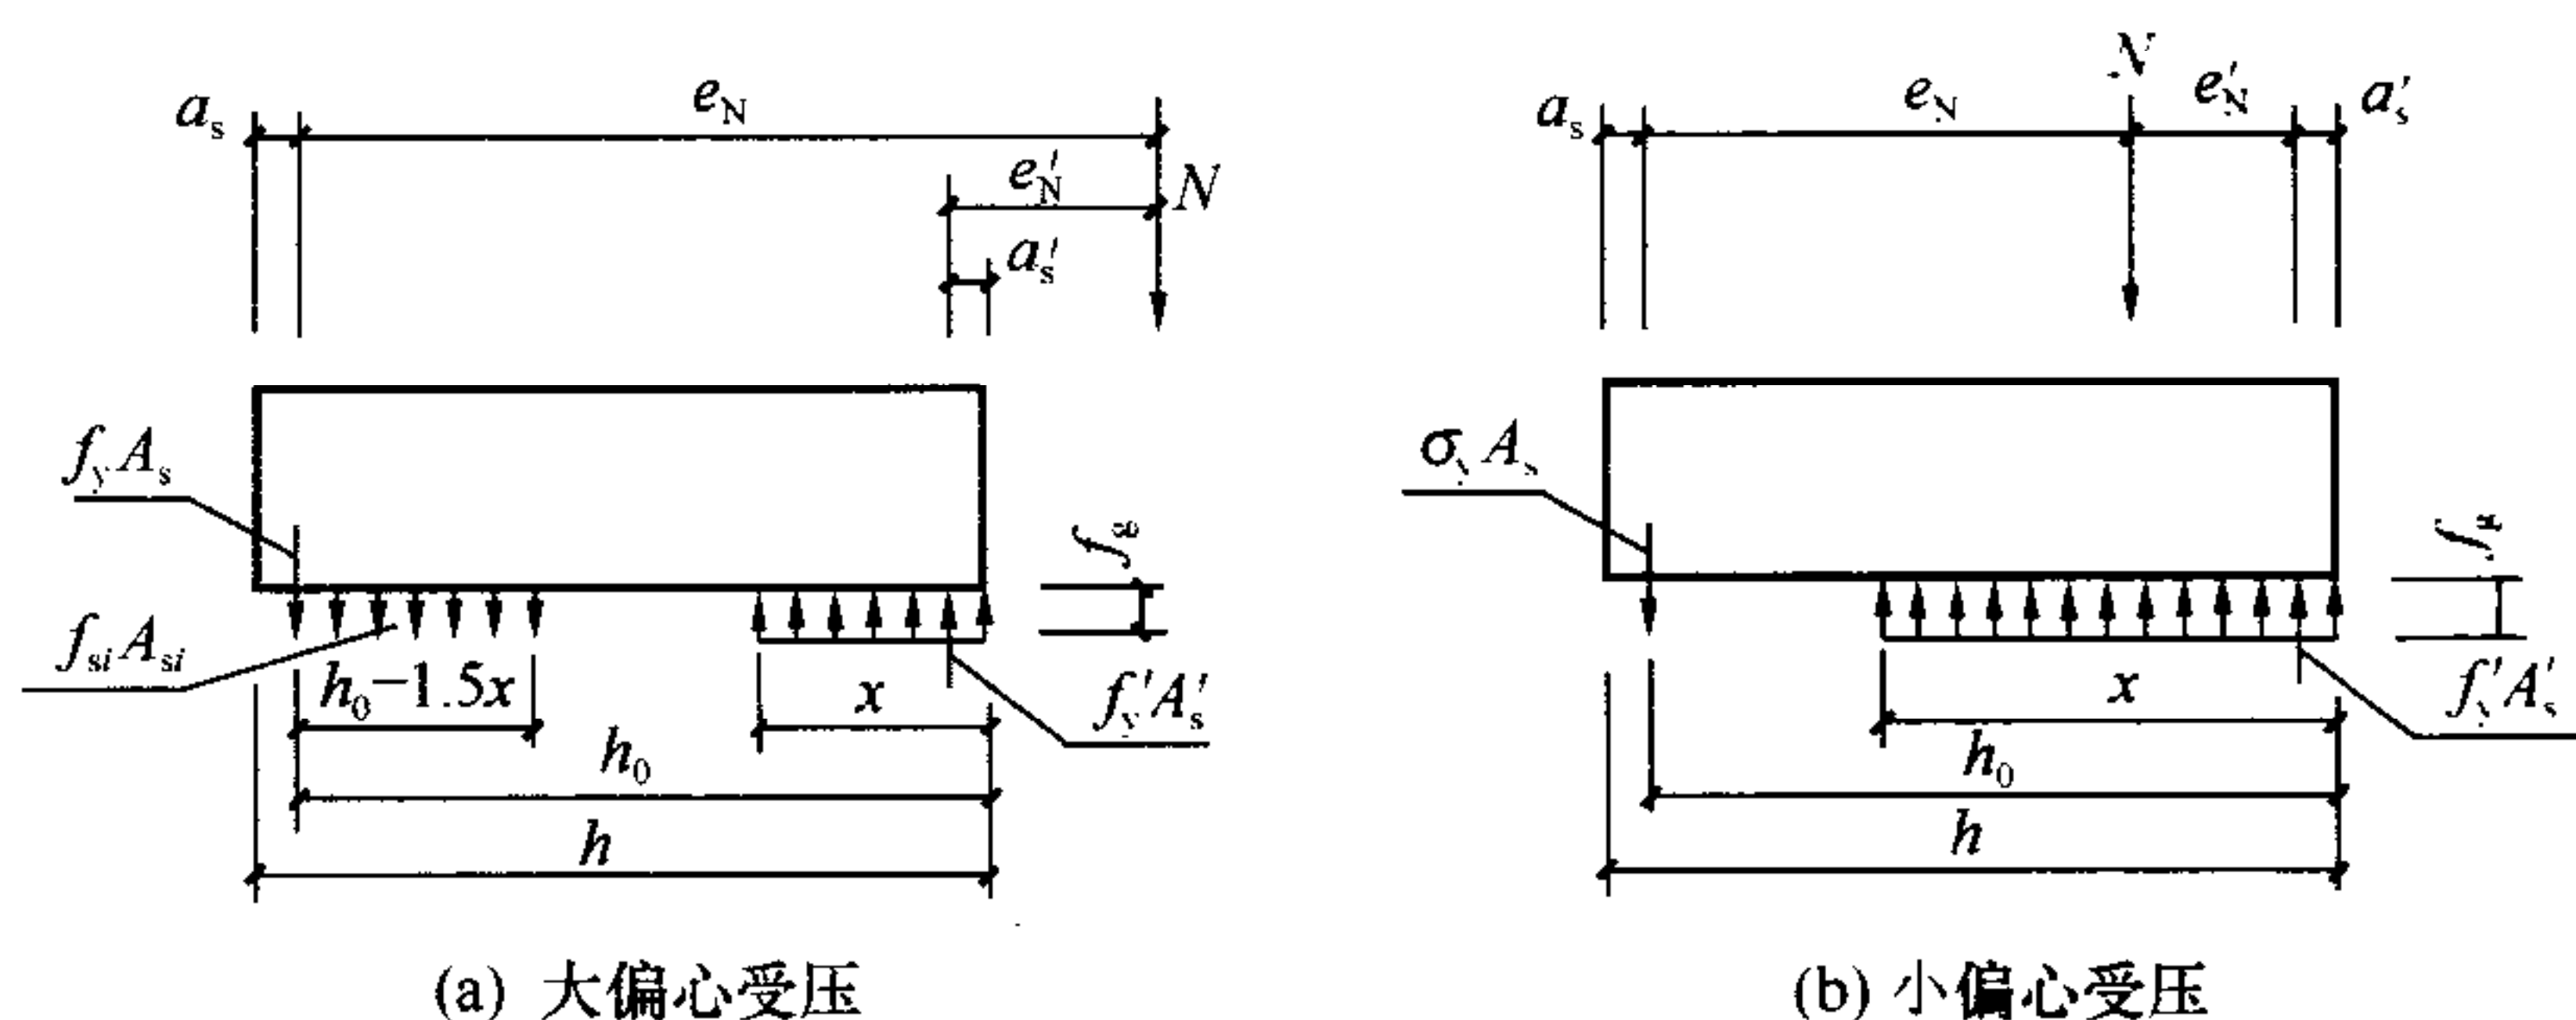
矩形截面偏心受压正截面承载力计算简图
